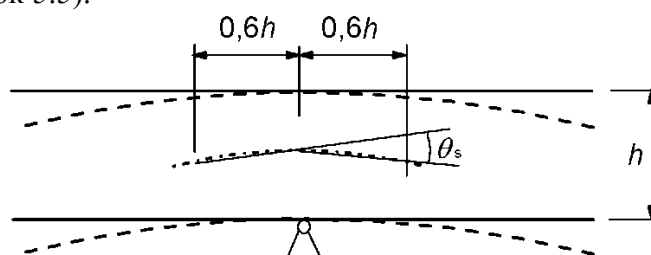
Угол пластического поворота θ_s для армированных поперечных сечений неразрезных балок и неразрезных плит, работающих в одном направлении
